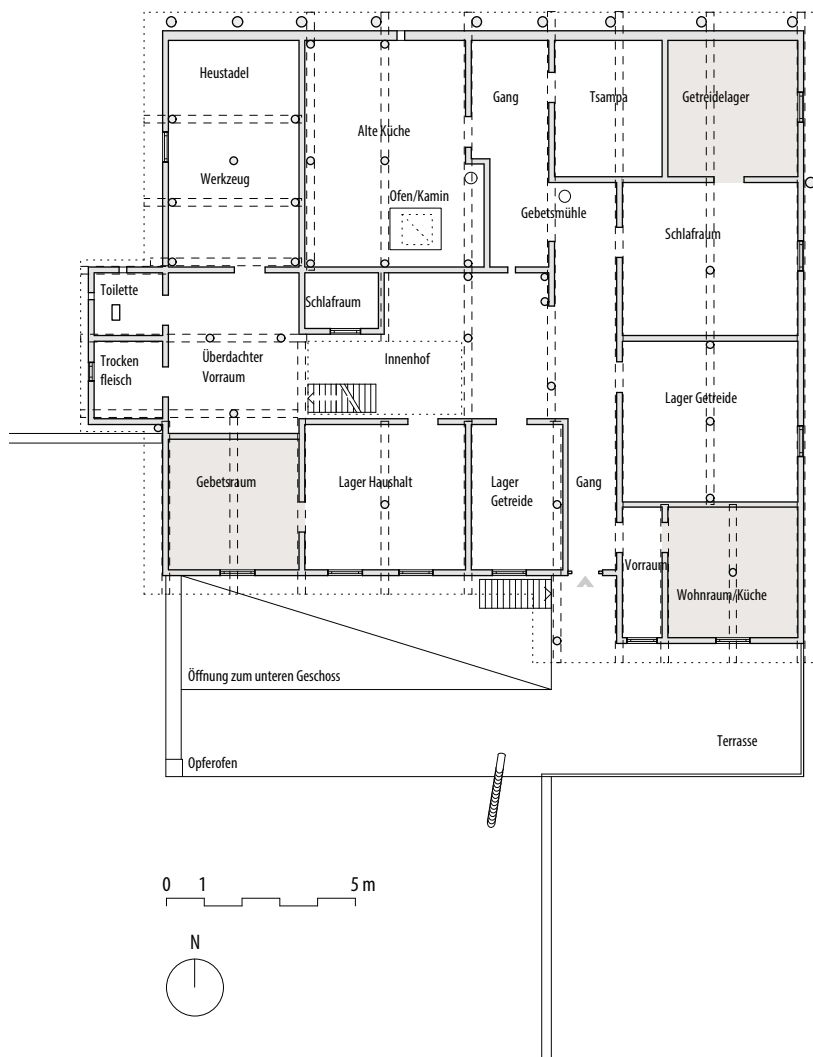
Grundriss erstes Obergeschoss.
